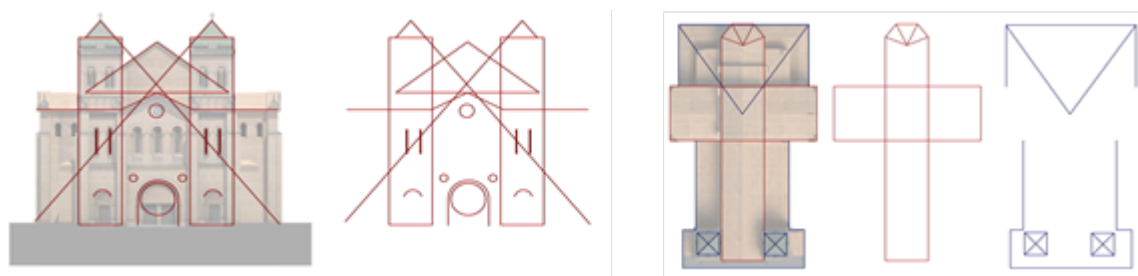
Geometría euclidiana encontrada en la fachada frontal y las cubiertas
